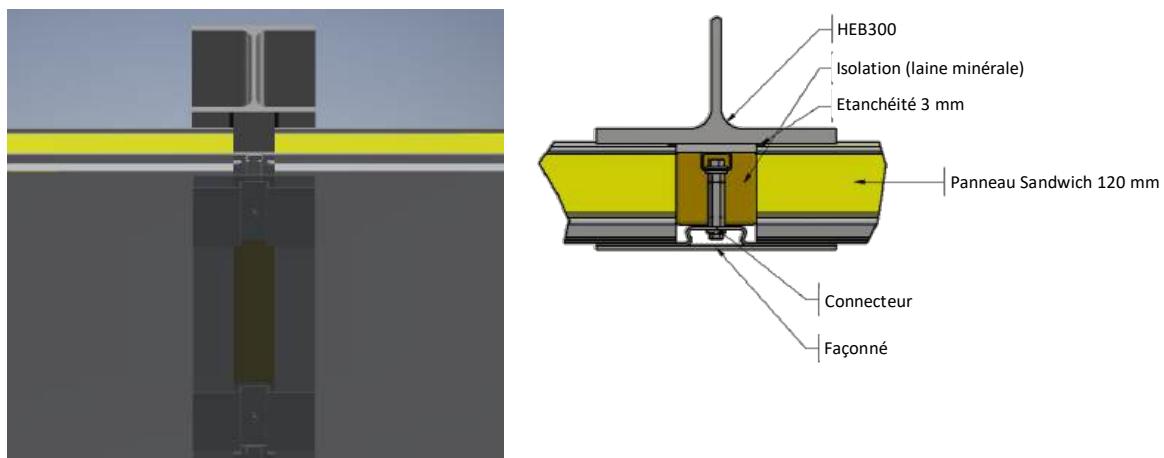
Système de fixation par serrage pour un bardage mural de longue portée
